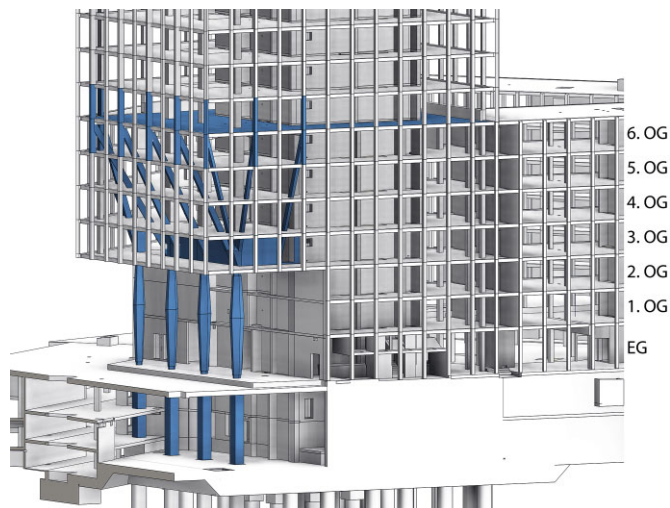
Überblick über die Abfangkonstruktion des Hochhauses in Stahlverbundbauweise
